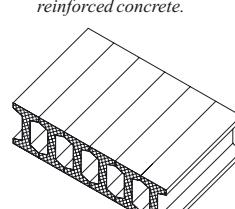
Plošča iz lahkega armiranega betona iz lamel.
